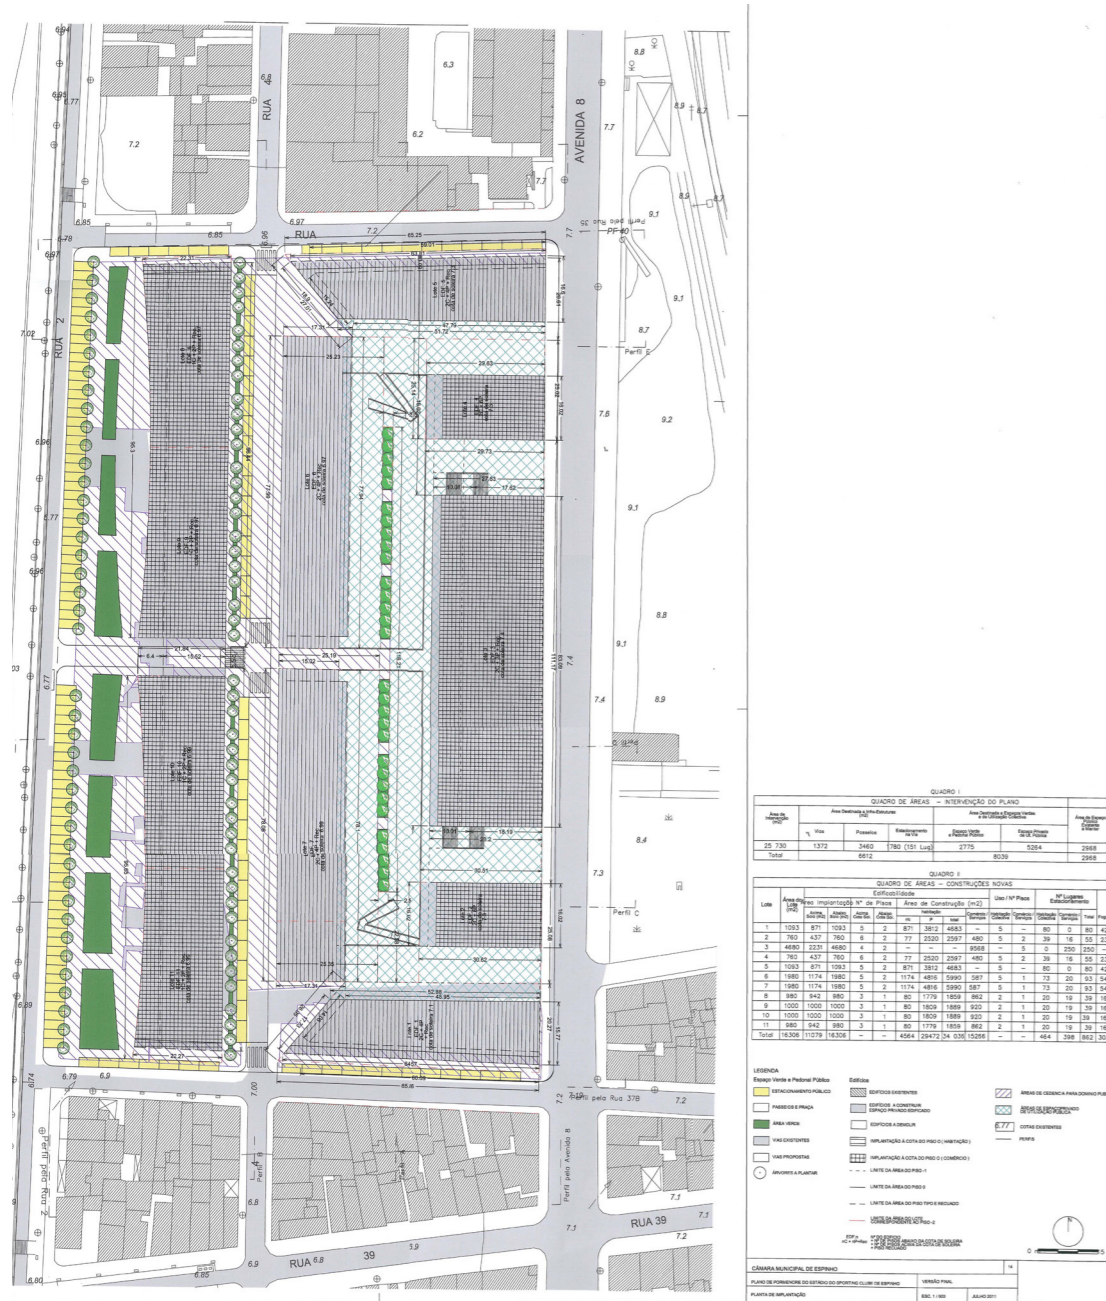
Planta de implantação do Plano Pormenor do Estádio do Sporting Clube de Espinho. Câmara Municipal de Espinho.
